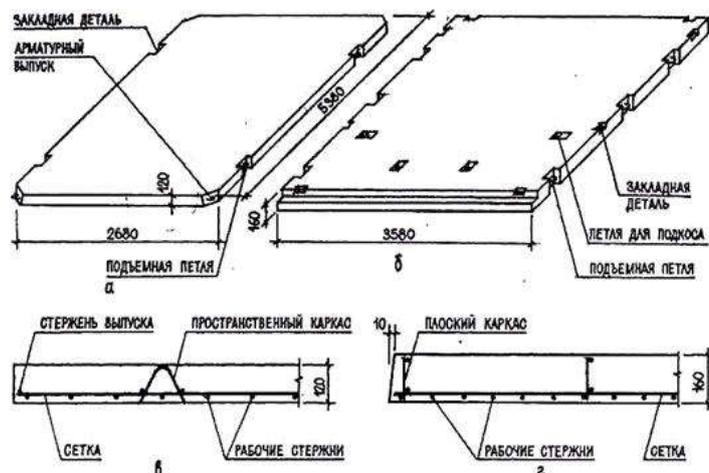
Сплошные плоские железобетонные плиты перекрытий: а,б – виды плит; в,г – армирование плит
